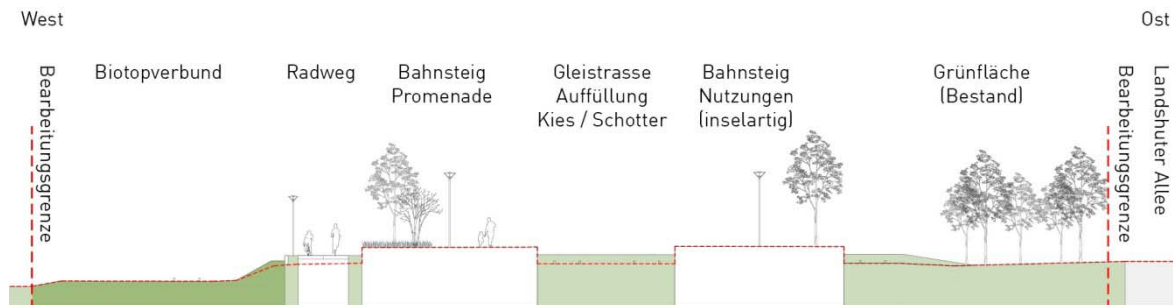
Wegeführung westlich der Bahnsteige (Verkleinerung, Originalmaßstab Schnitt A-A' 1:200)
